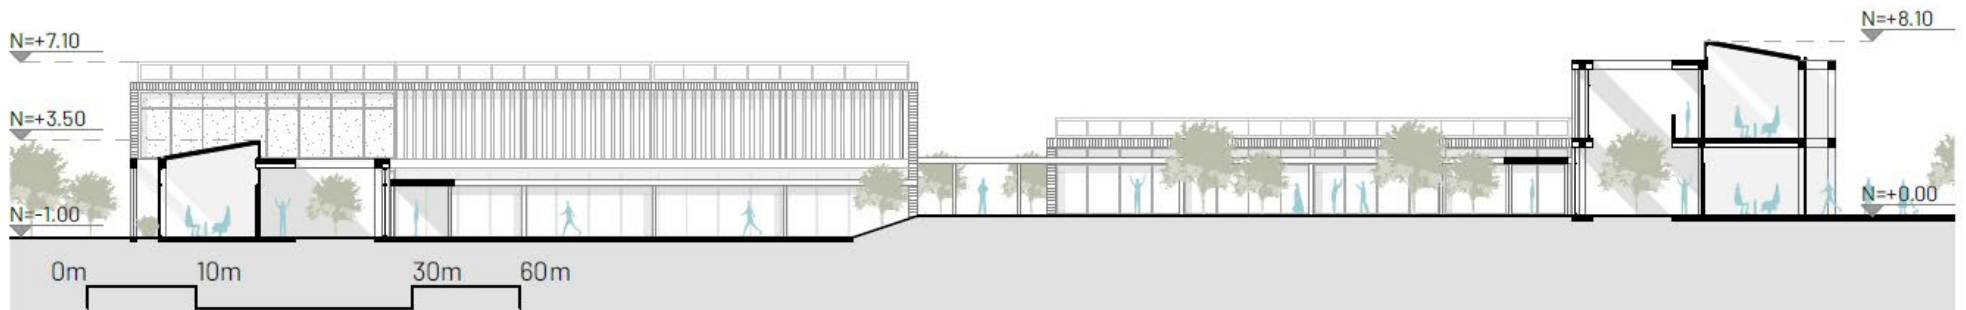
| Sección Transversal | Fuente: Autoría propia. (2023).
